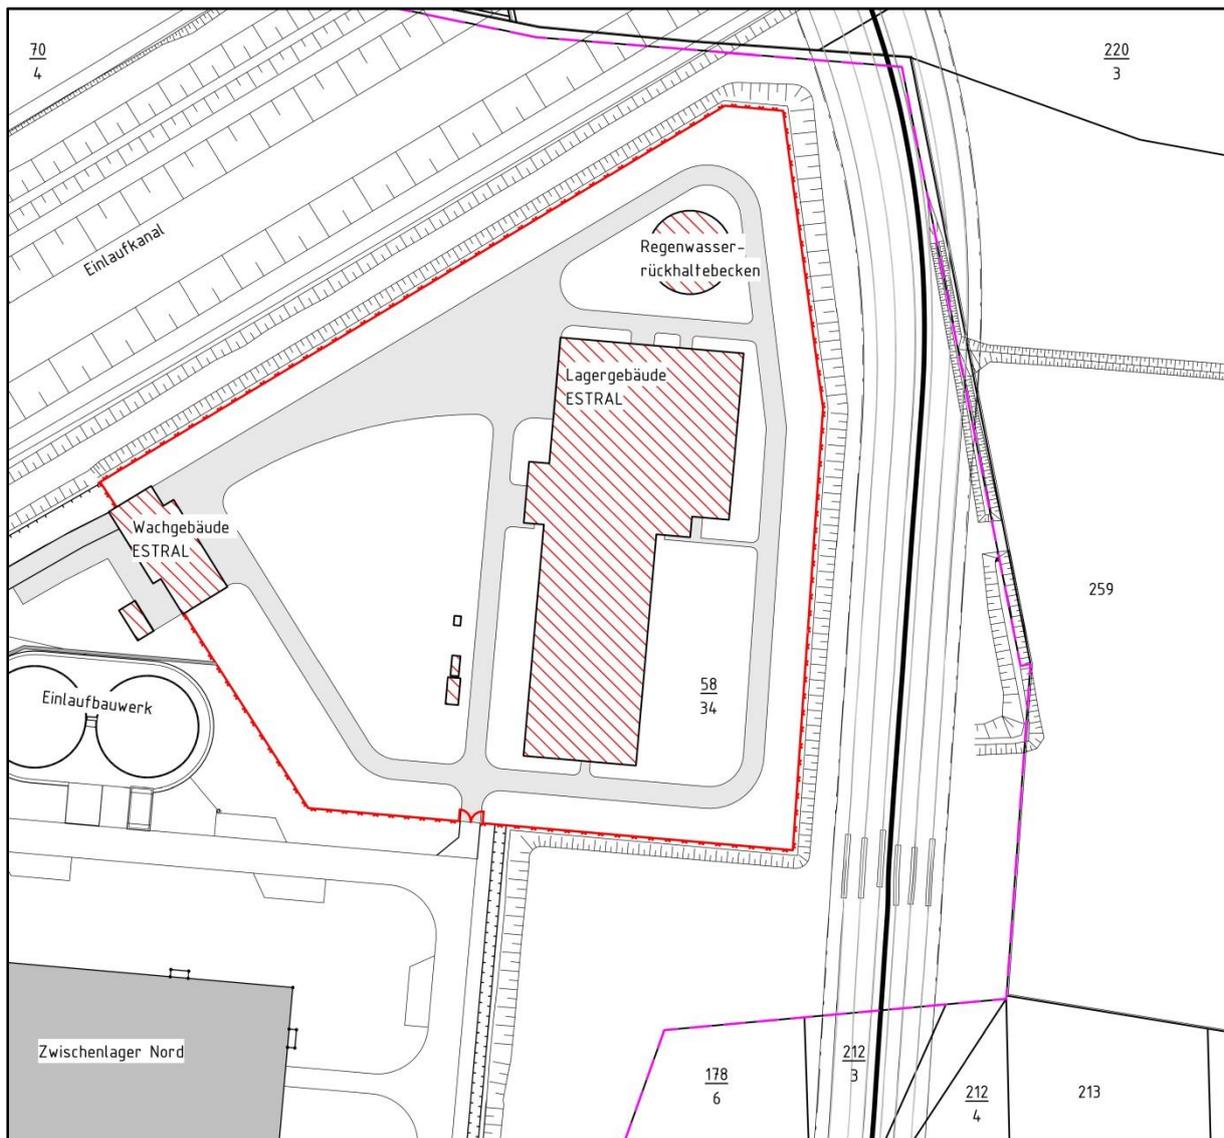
Flurkarte (Ausschnitt) mit Kennzeichnung der Baufläche ESTRAL
